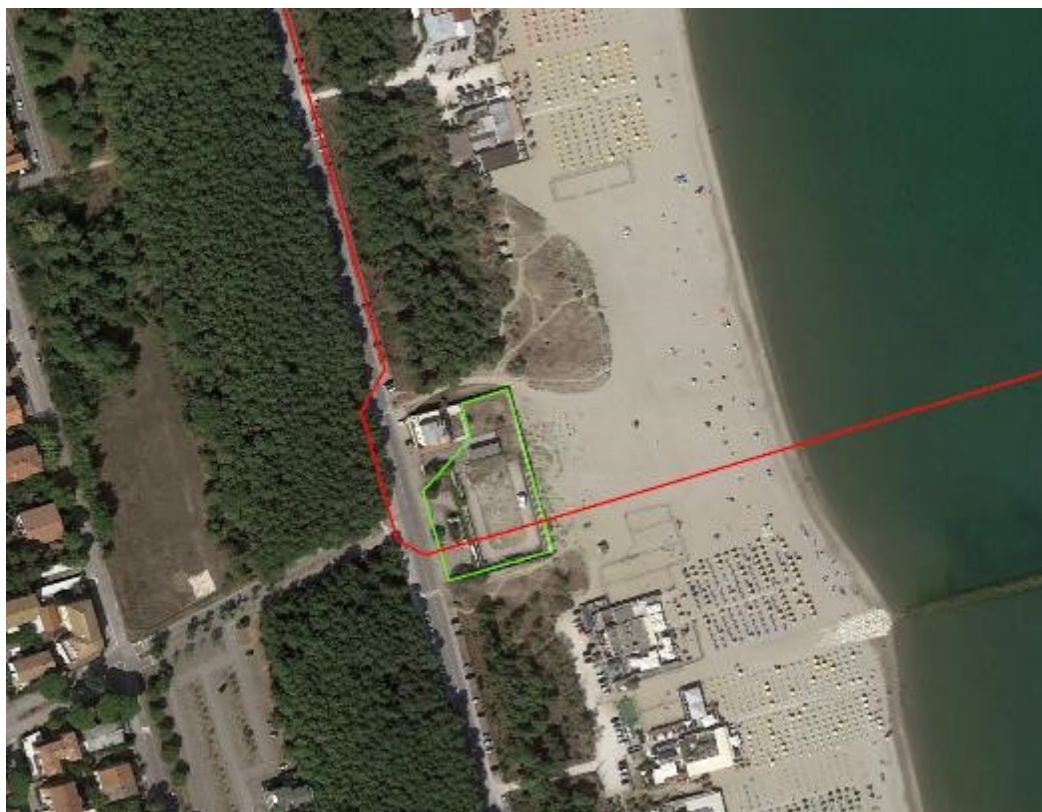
Area di lavoro del microtunnel a Ravenna. In verde l'area di lavoro per postazione di spinta microtunnel a Ravenna, in rosso il metanodotto in progetto
